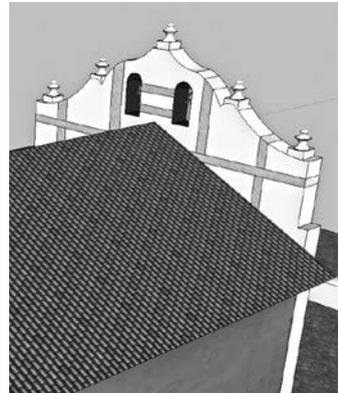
Schema prospetto principale chiesa di Nicoya
